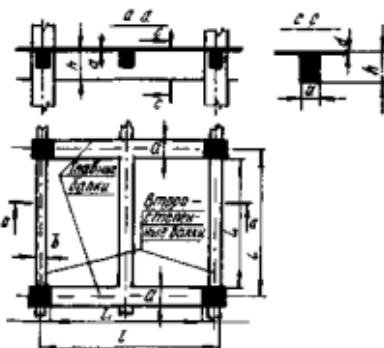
Фрагмент железобетонового ребристого перекрытия.
